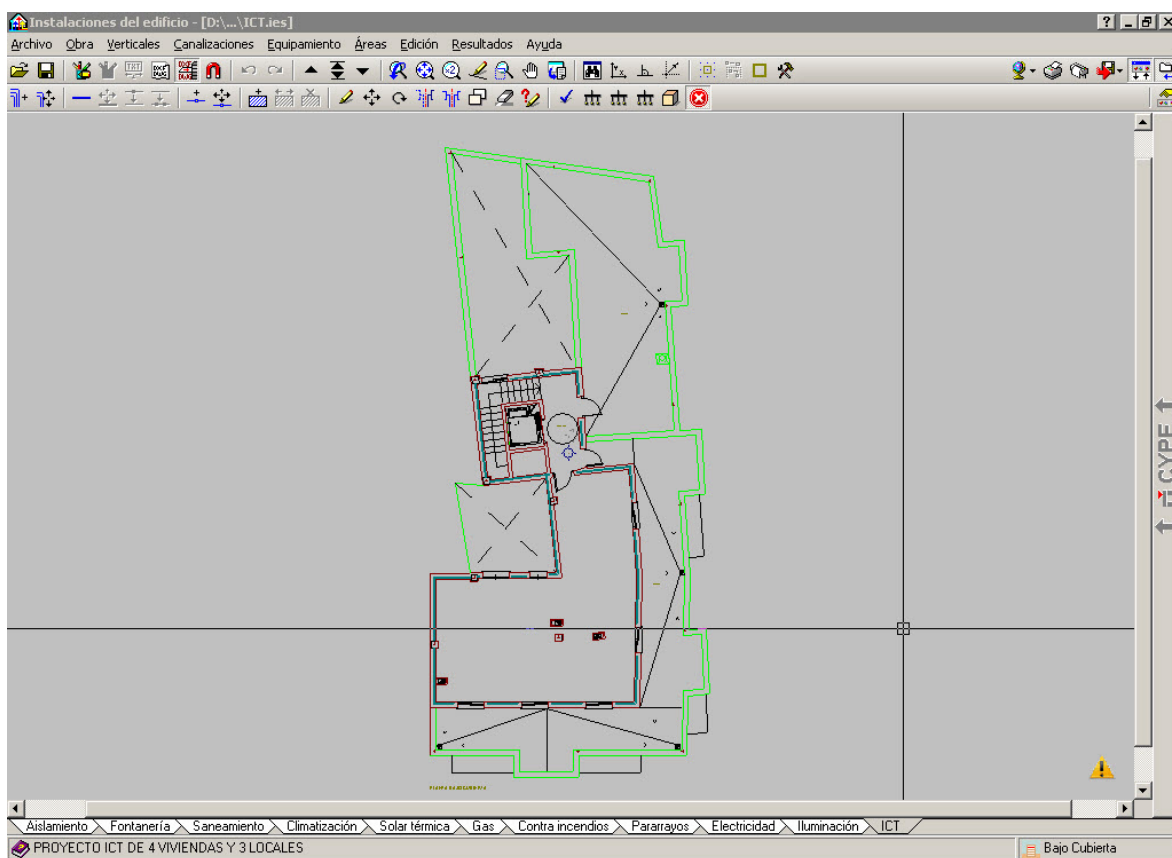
Instalación ICT planta bajo-cubierta (dimensionada)
